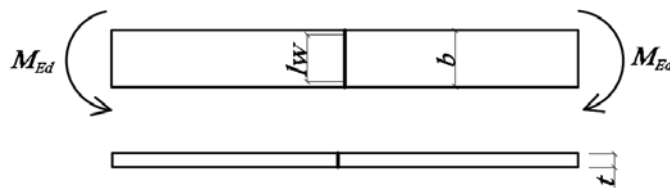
К расчету стыкового сварного шва при действии изгибающего момента
